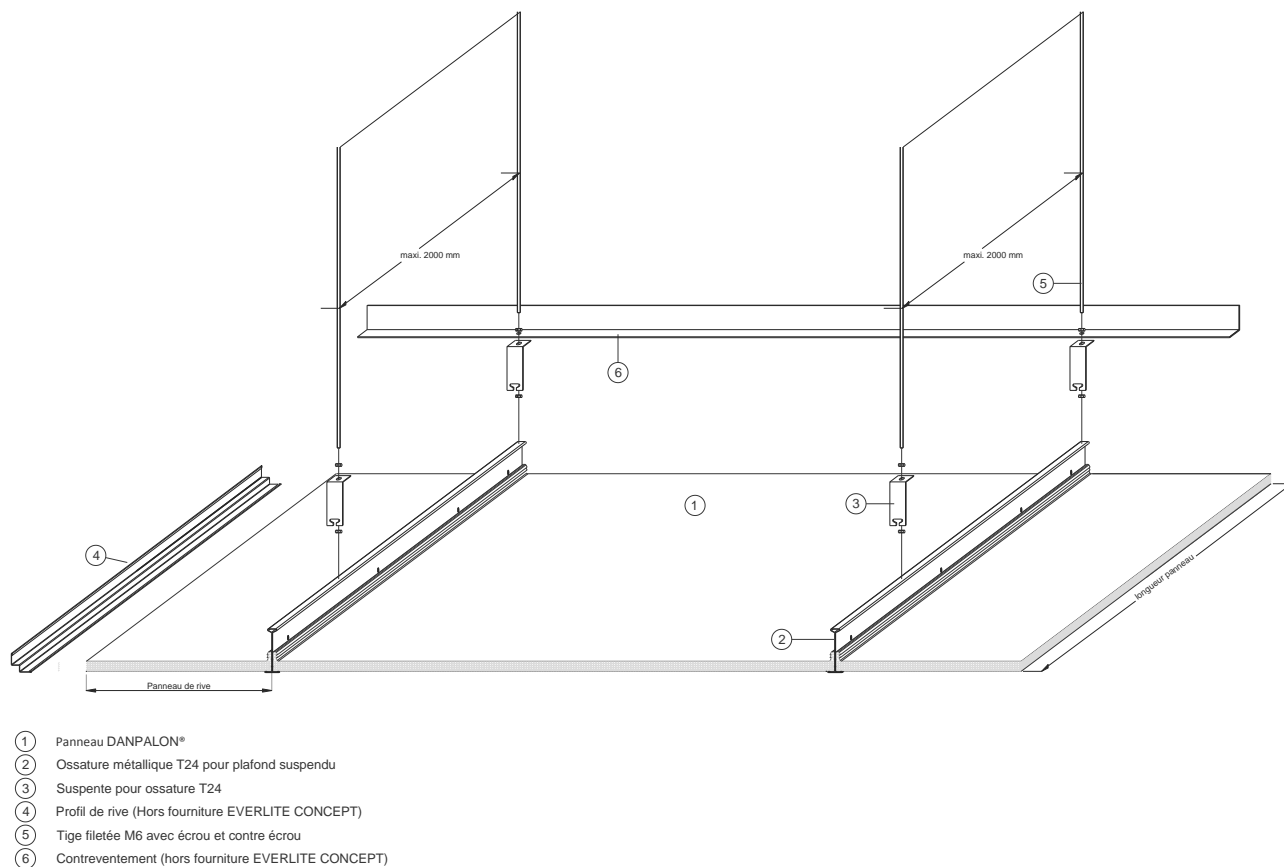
Pose sur T – système DANPALON® application plafond suspendue
